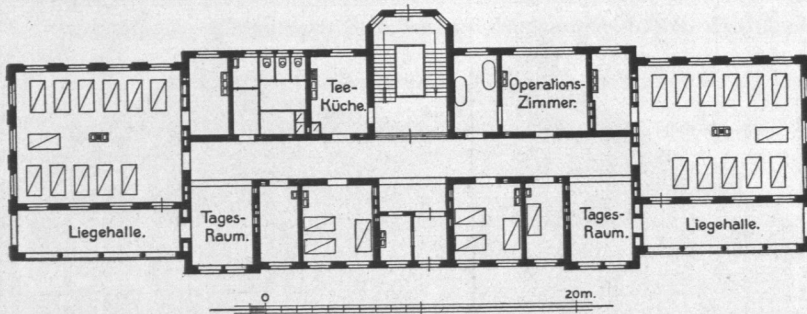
Allgemeines Krankenhaus Hamburg-Barmbeck, chirurgisch-septischer Pavillon, Erdgeschoß, Grundriß.
